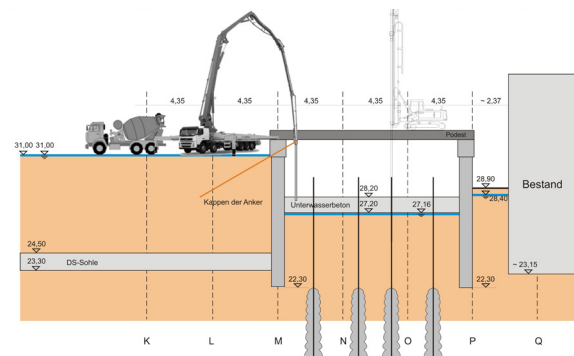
Tempietto ausgeführte Variante: Unterwasserbetonsohle
